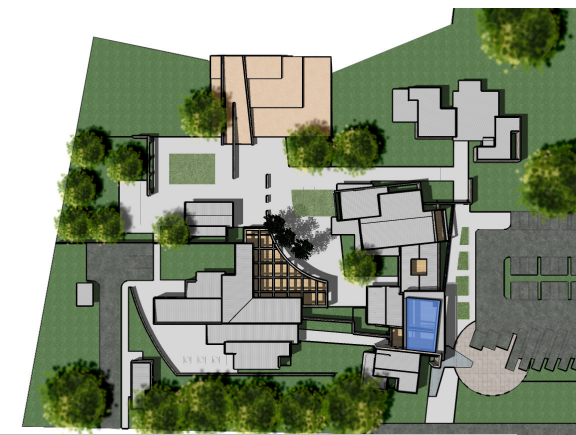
Perspectiva en planta del complejo arquitectónico
